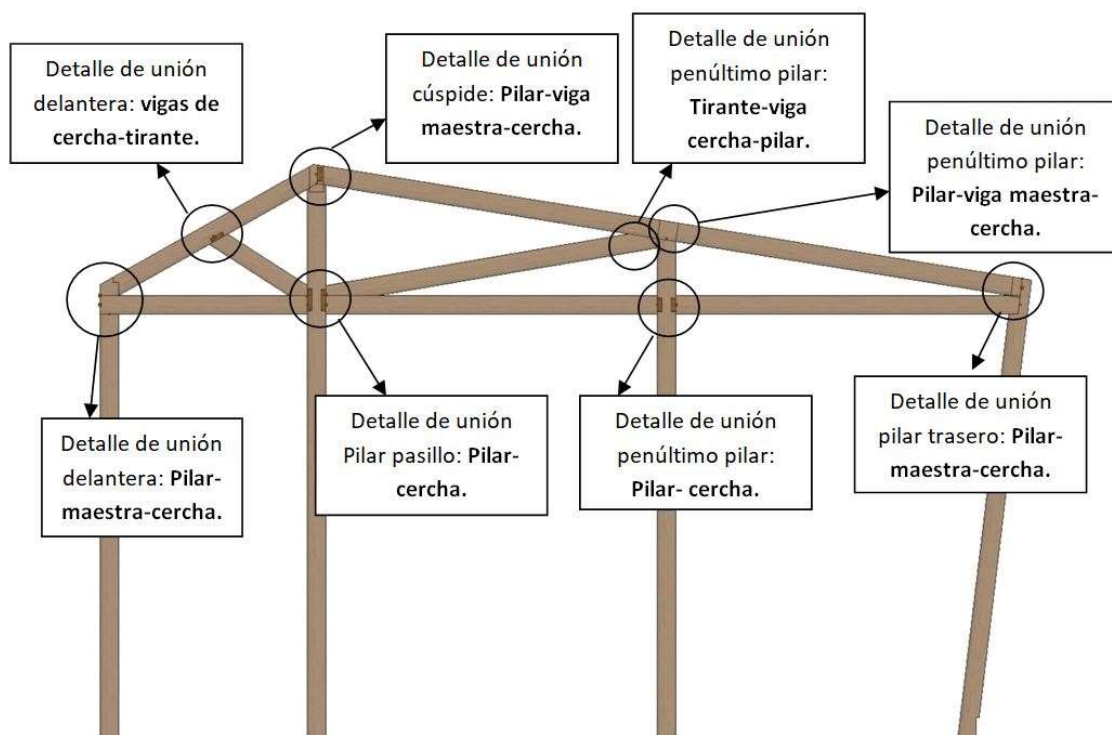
Cercha exterior. Detalles de unión. Imagen de Cadwork.
